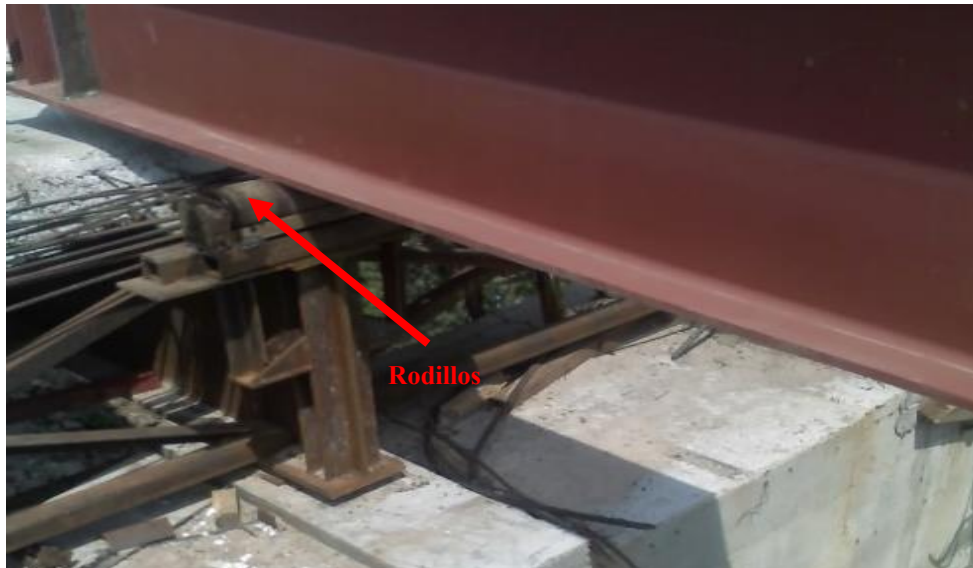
Rodillos metálicos colocados debajo de las vigas principales para el deslizamiento.
